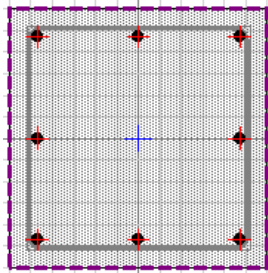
Sección de columna 60x60 con refuerzo longitudinal $8\phi 25\text{mm}$.
